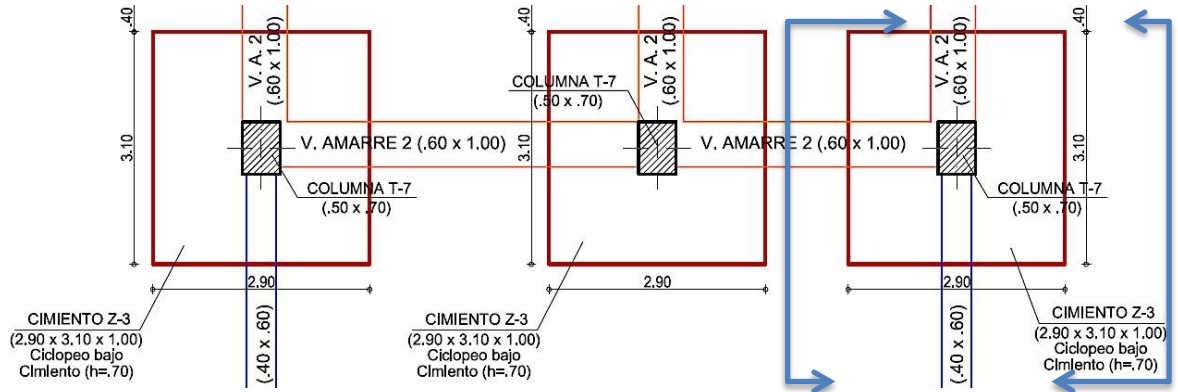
Vista en planta de la zapata D-6, vigas de amarre Tipo 2 y columna tipo T-7.
